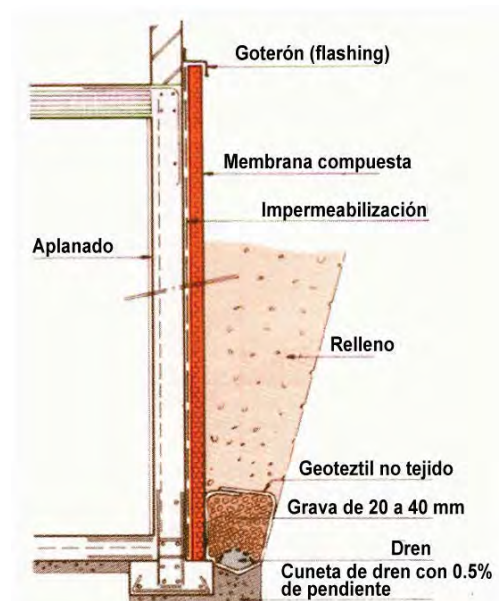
DRENADO CON CUNETA DE DREN, DREN Y GEOTEXTIL NO TEJIDO (Opción 2)
